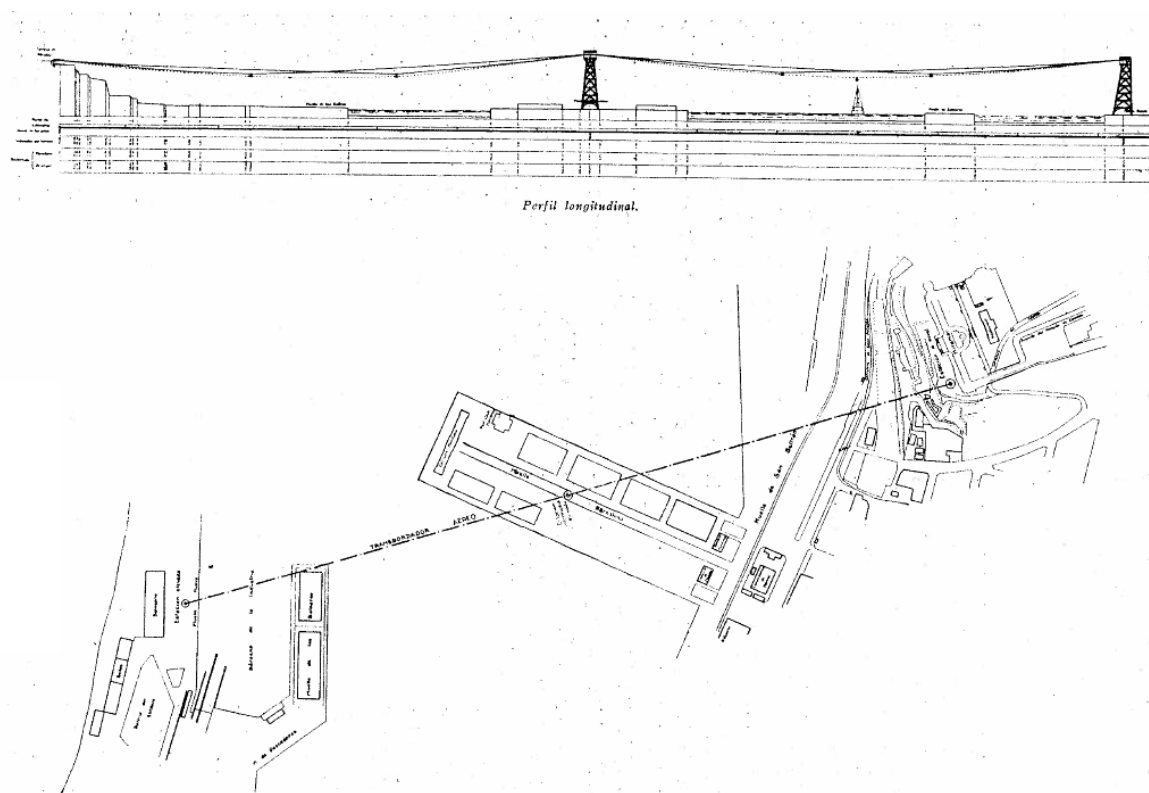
Vista longitudinal y plano de situación del teleférico del puerto[8]
